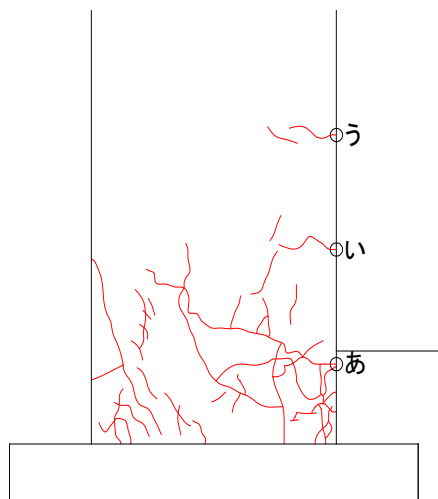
柱ひび割れ幅測定位置(試験体 A-7b 負荷荷)
